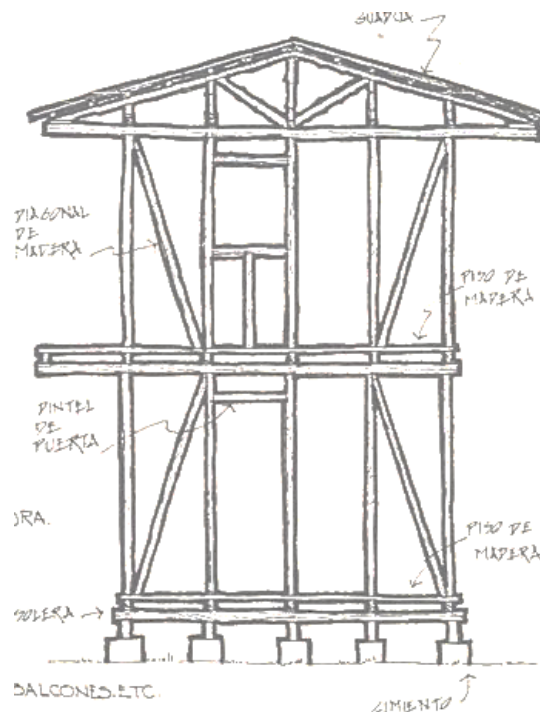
Alzado de estructura de madera en torre para vivienda. Sistema constructivo bahareque, donde se diferencian los conjuntos constructivos de: cubierta, estructura y cimiento.
